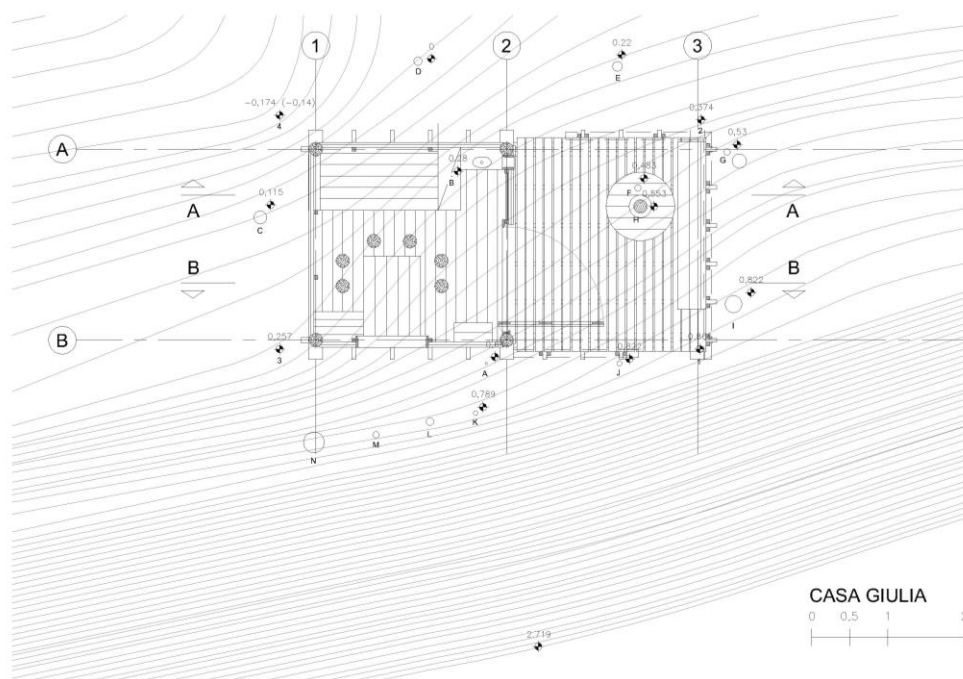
Desenho técnico da casa Giulia. Desenho: Alexander Chang.
